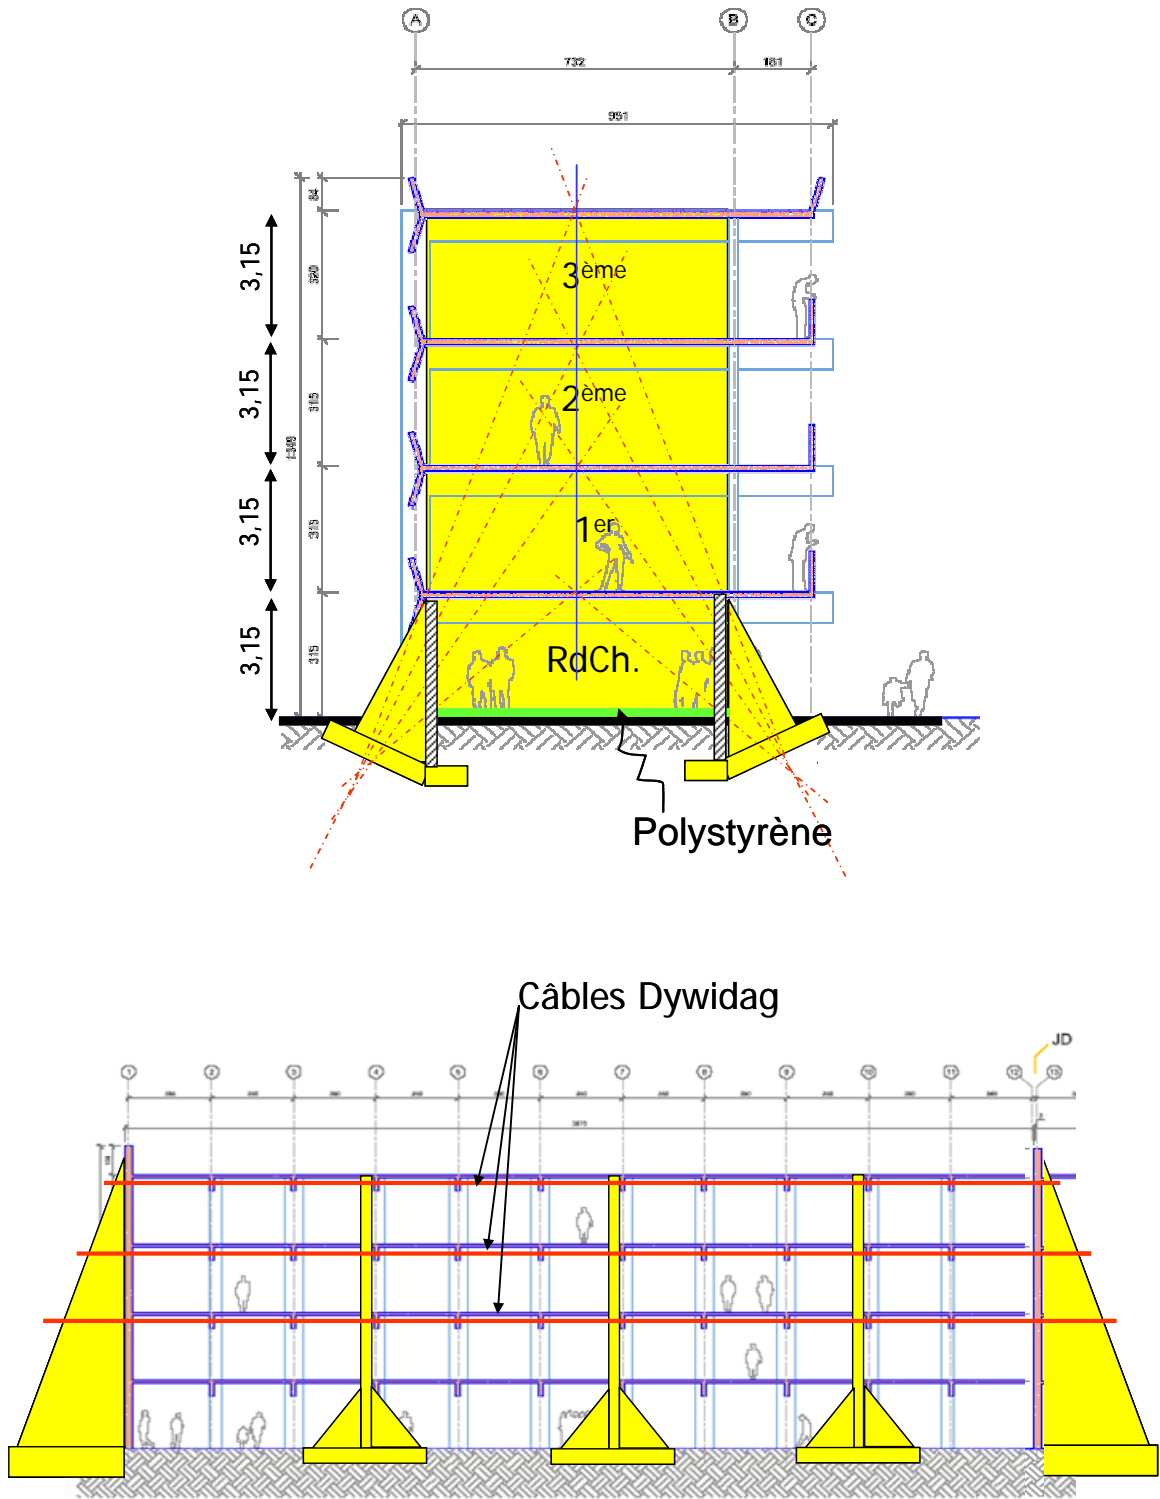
Renforcement transversal par voiles en béton armé projeté et renforcement longitudinal par contreforts en béton armé
